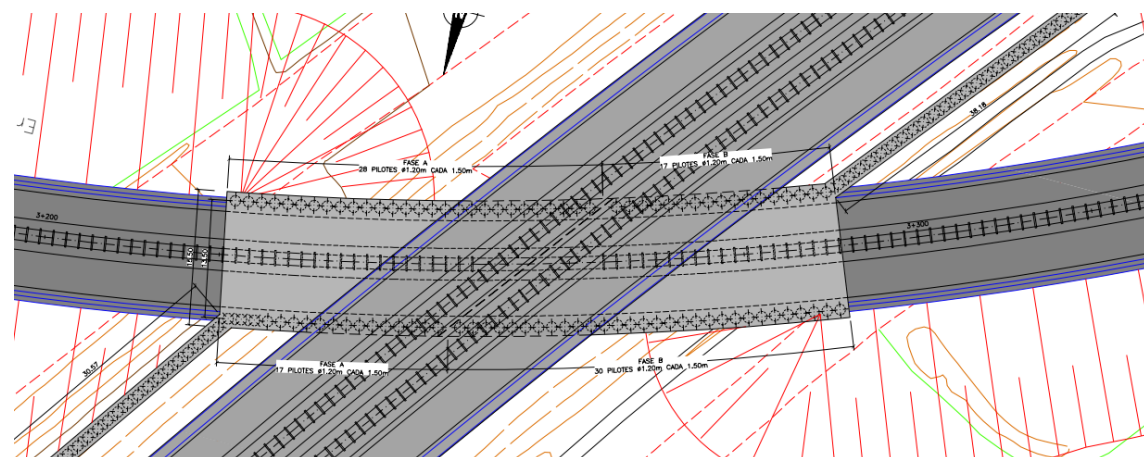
PLANTA PASO BAJO PLATAFORMA LAV P.K. 3+240
